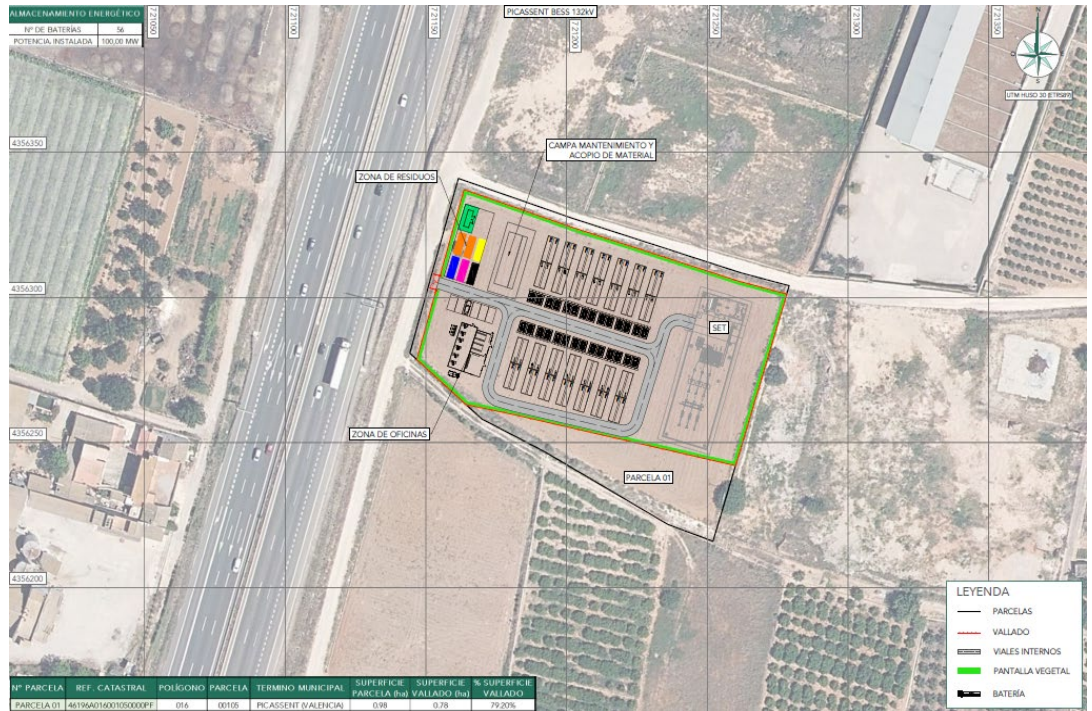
Implantación de la planta de almacenamiento PICASSENT BESS 132 KV. (Fuente: Promotor)
